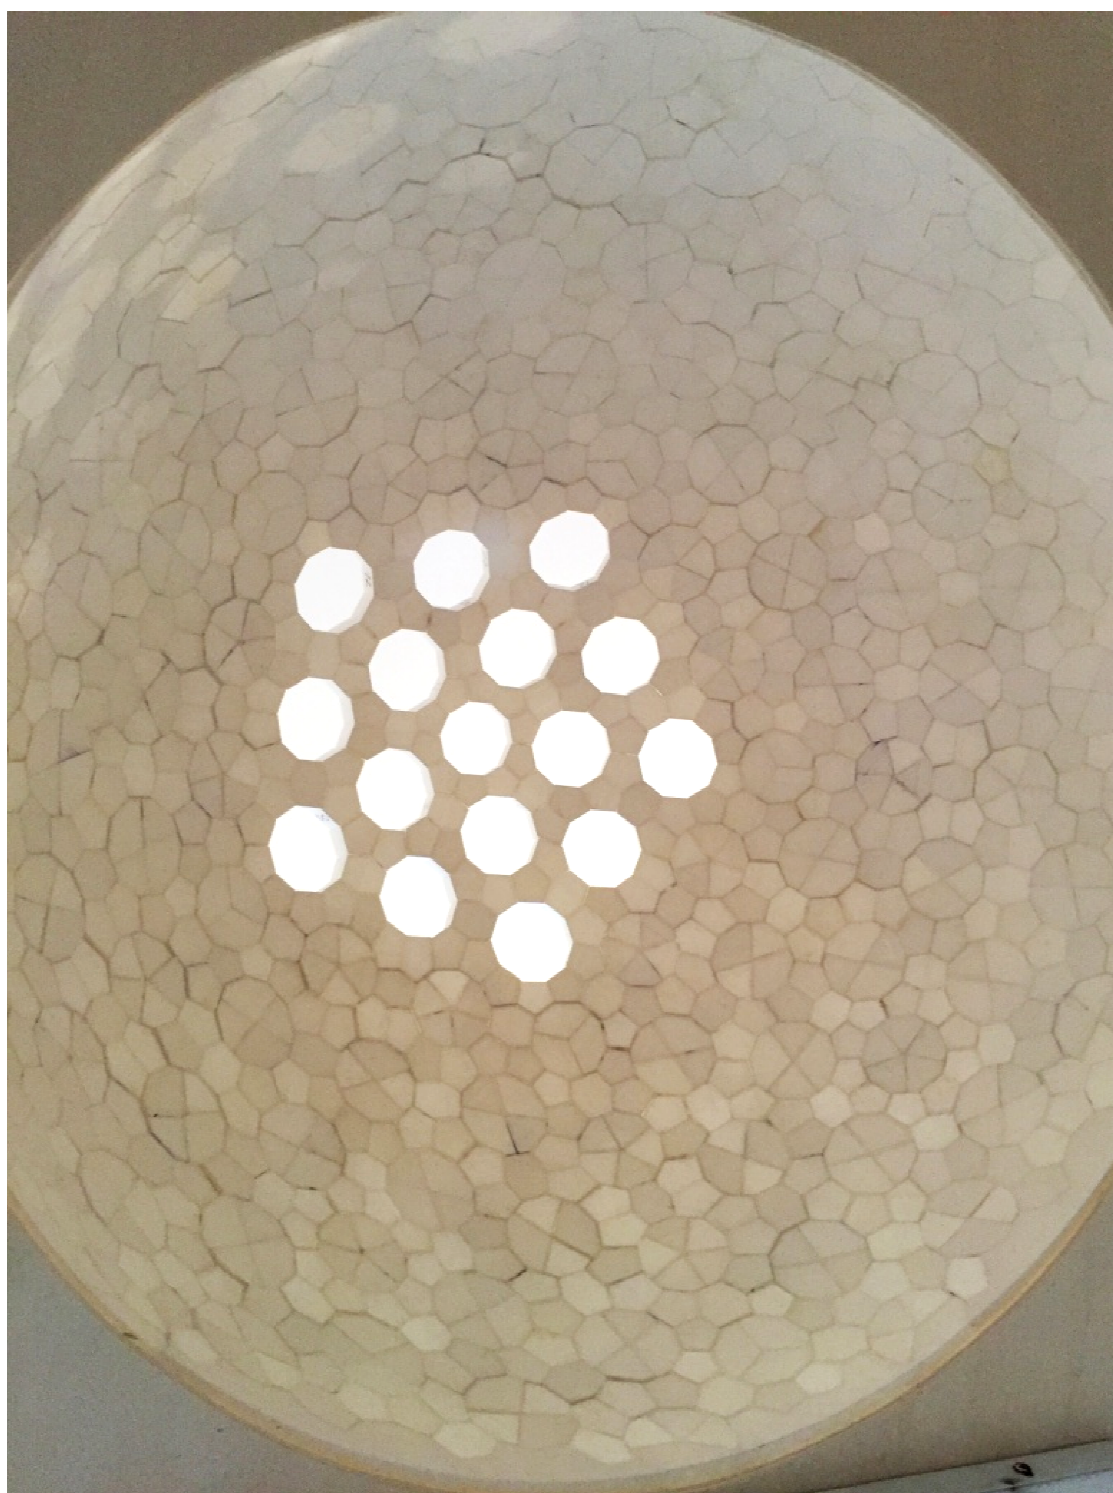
Fase 6, montaggio completo della maquette, vista dall'alto,
